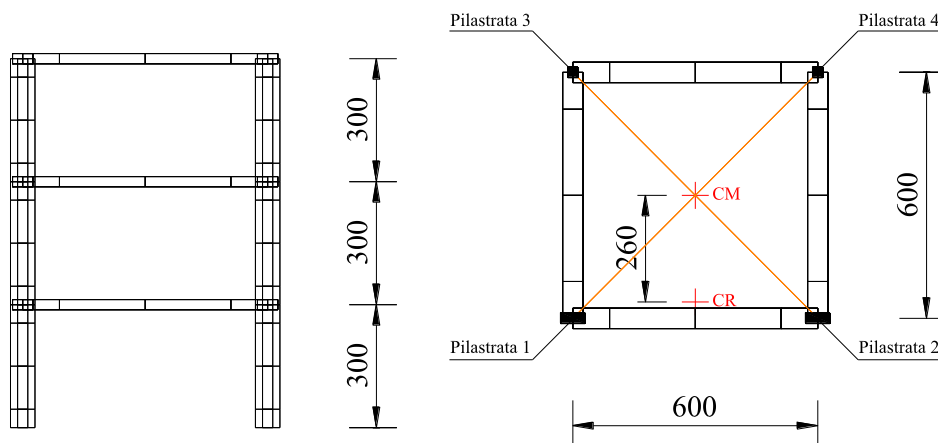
Prospetto e pianta della struttura con suddivisione in elementi finiti.
